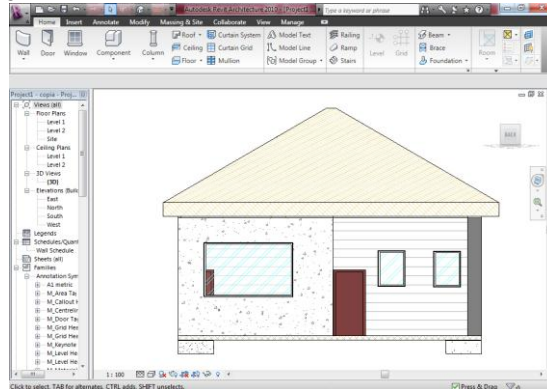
Reforma de fachada (adición de ventanería, disminución de mampostería, cambio de material de columna)
